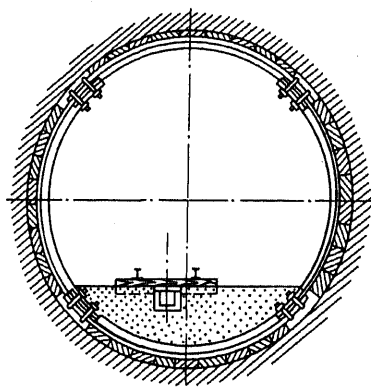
Конструкция кольцевой металлической податливой крепи
